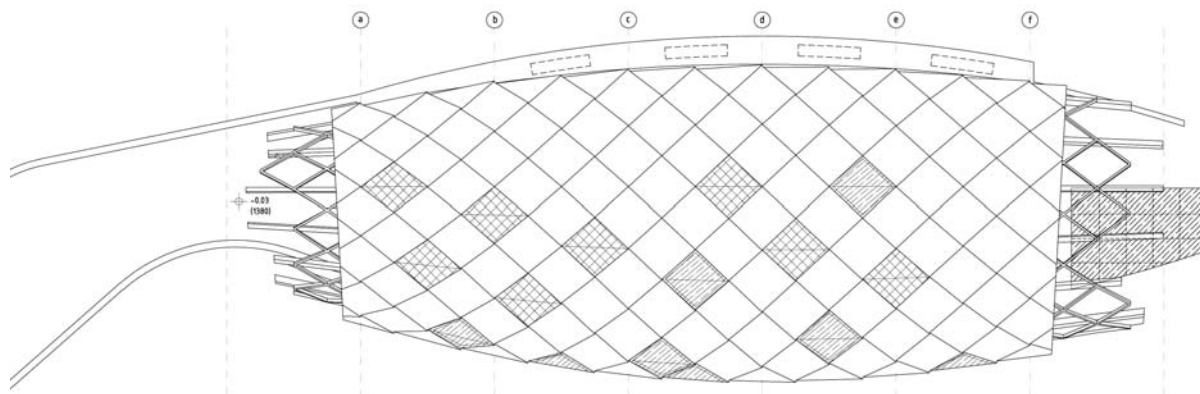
Foto da progetto – Inserimento dell’edificio nel contesto
